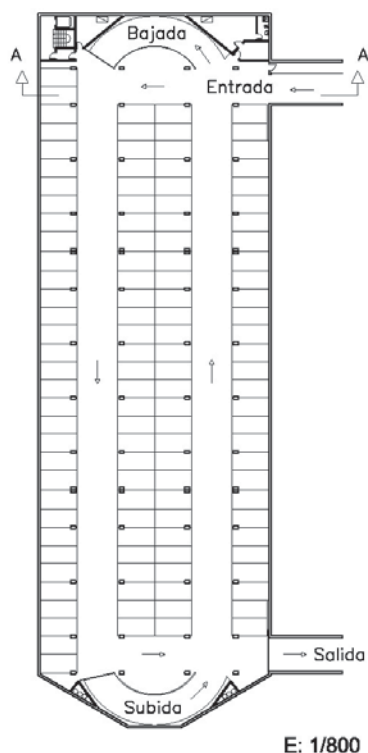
Planta de acceso (4º) del aparcamiento subterráneo de 500 plazas diseñado para la comparativa económica.
